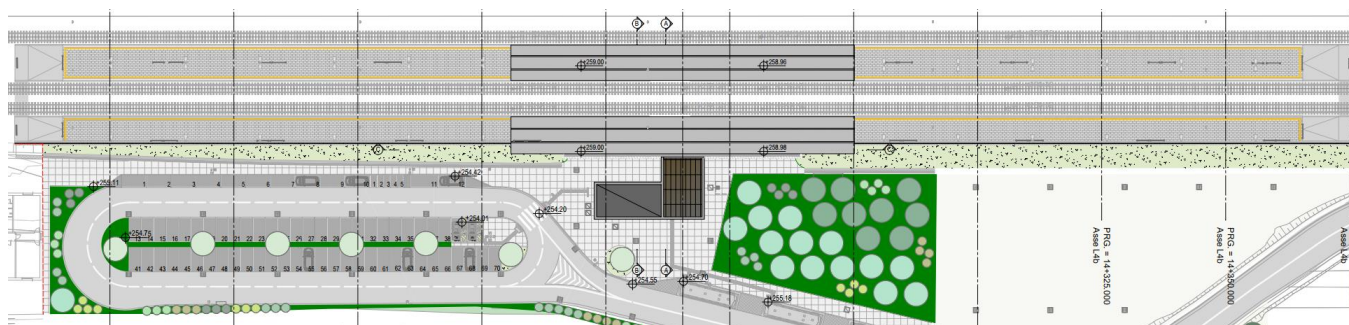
Stazione di Dittaino - Planimetria generale fase definitiva
